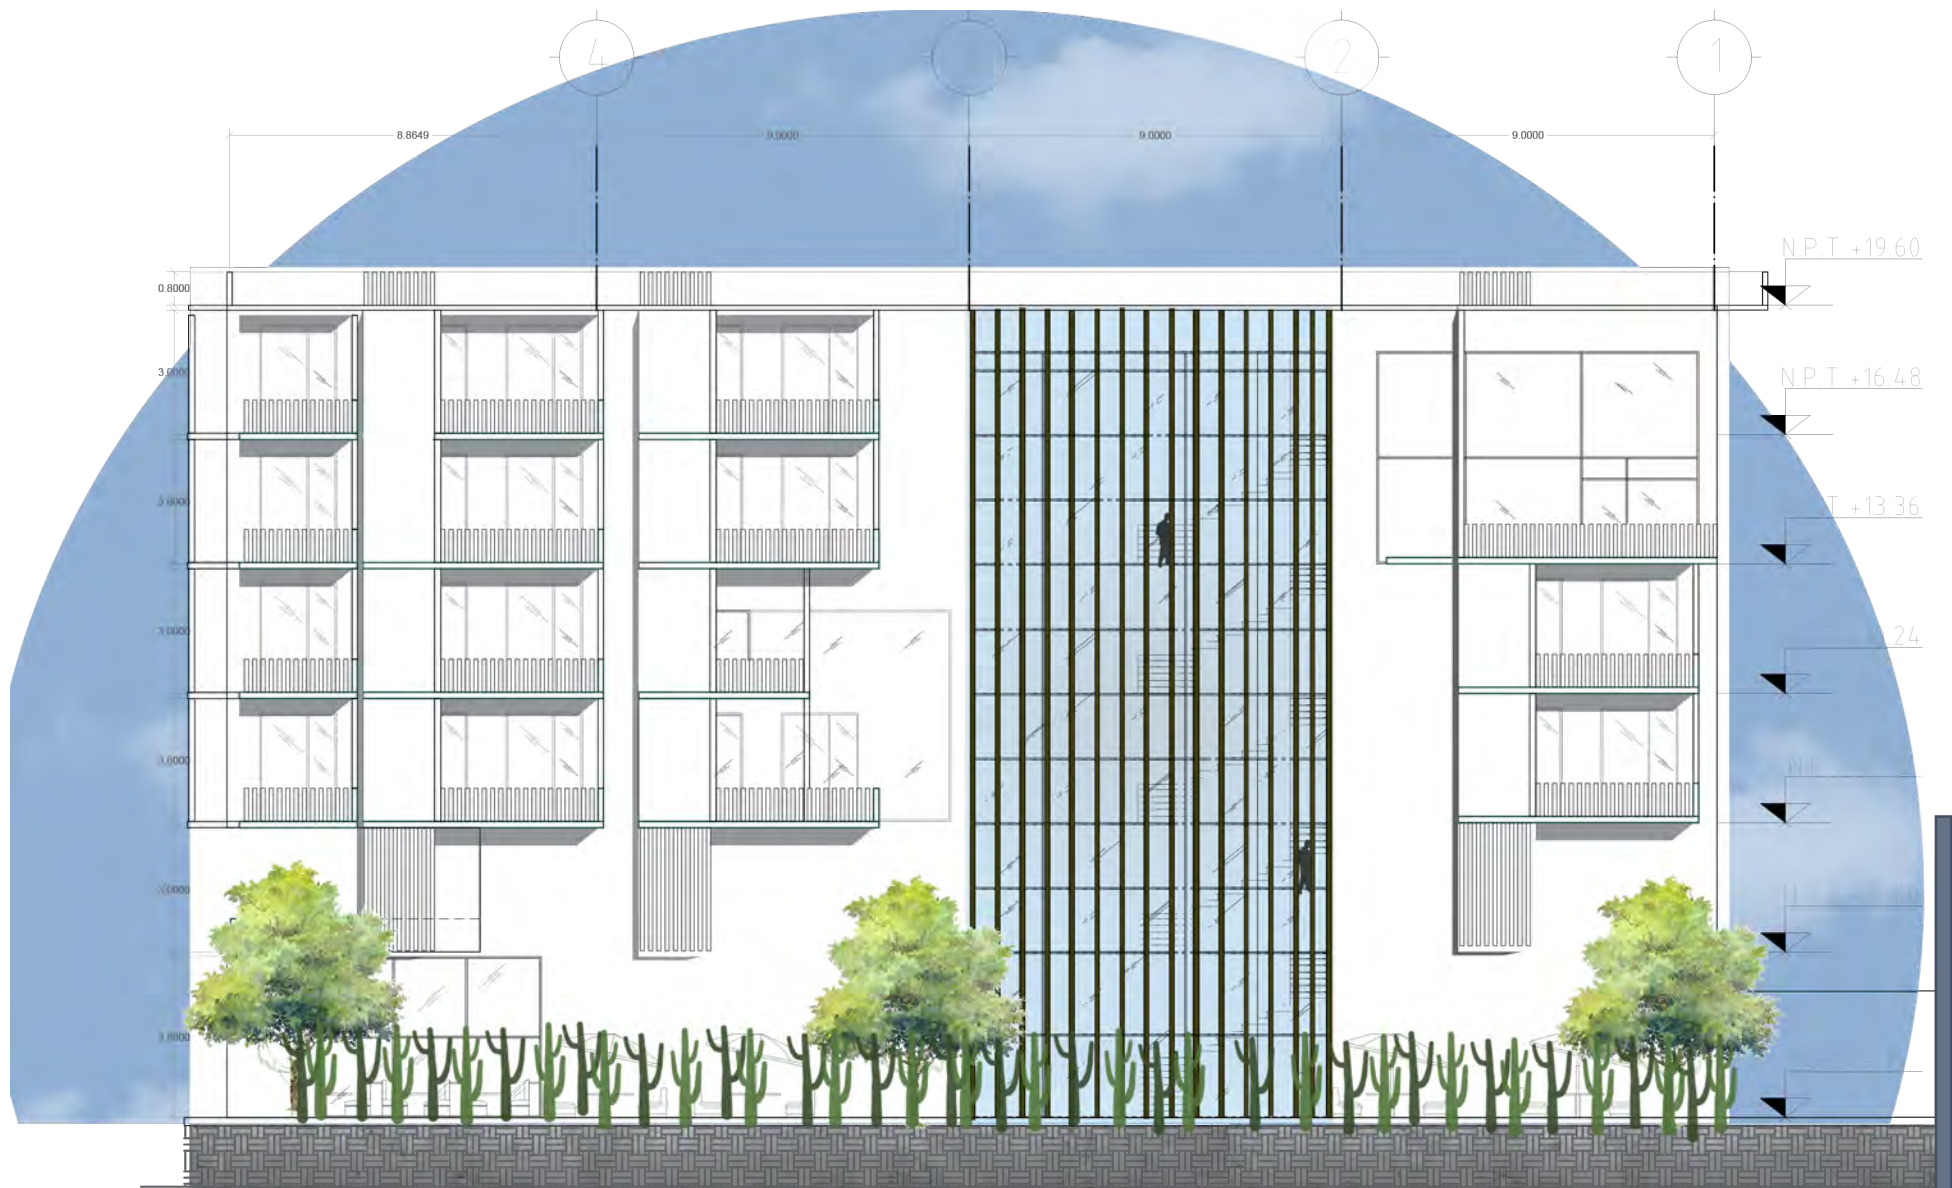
Facha interior del conjunto vista desde el corredor, elaboración propia 2022
